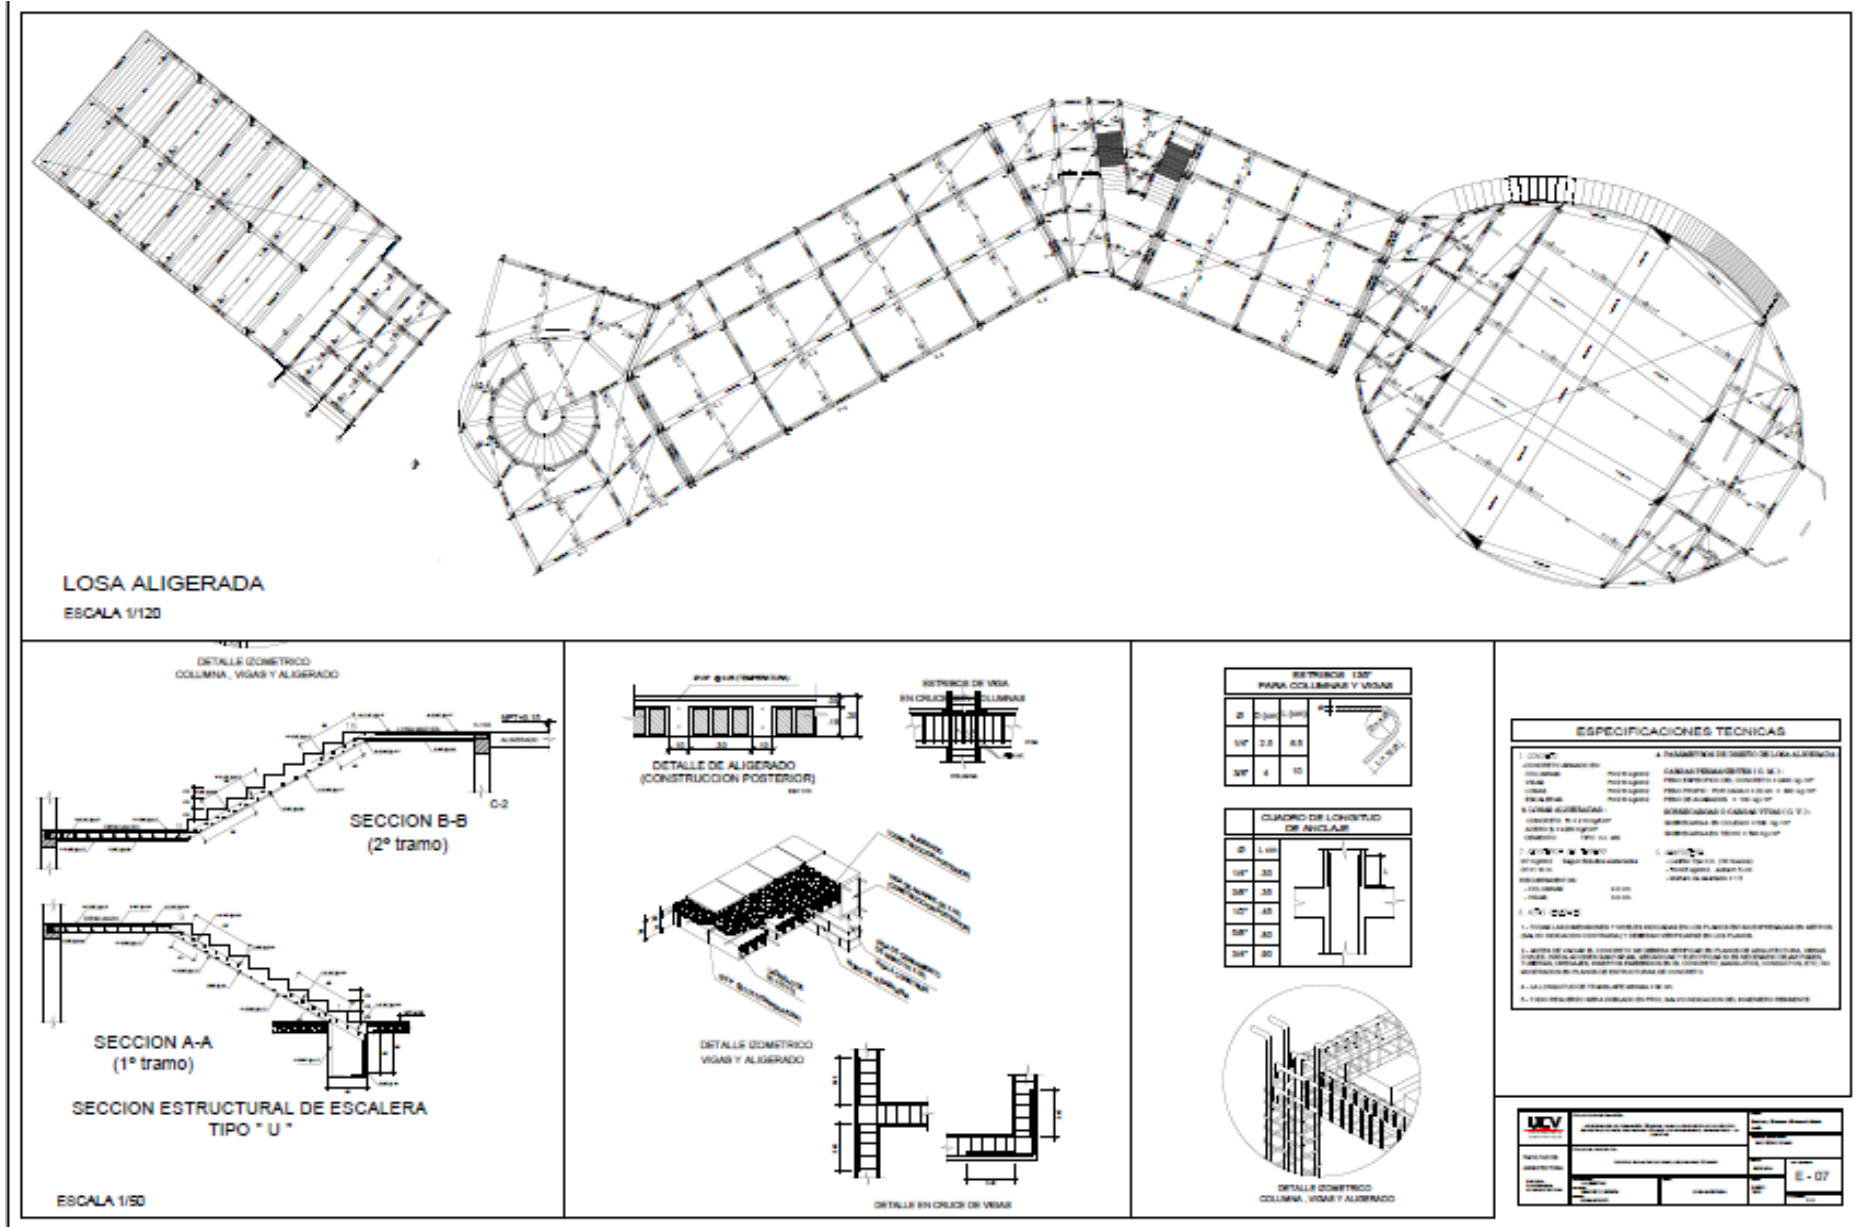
Plano Diseño Estructural General – Losa Aligerada - Plano N° 15 - Lamina E-07
